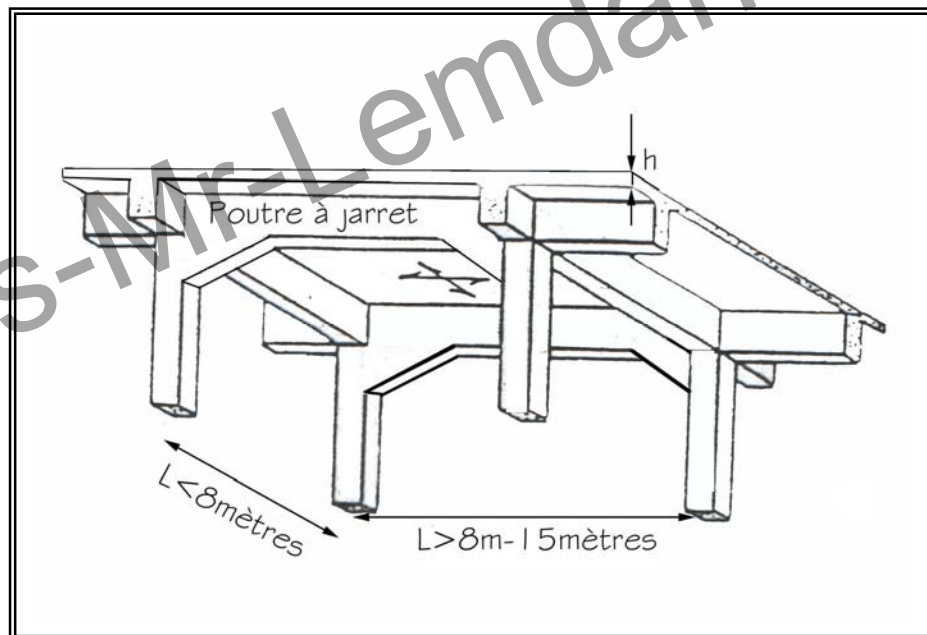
Dalles pleines à répartition bidirectionnelle sur poutres.
